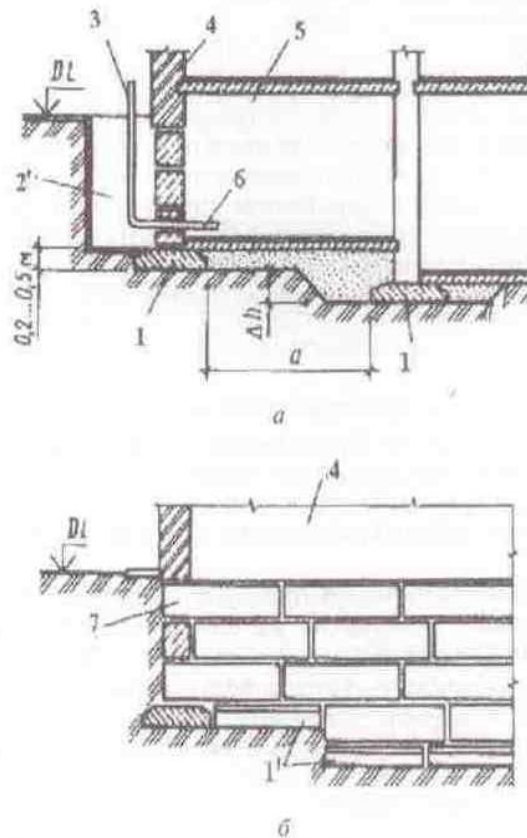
Вибір глибини закладання фундаменту в залежності від конструктивних особливостей споруди: а – будівля з підвалом у різних рівнях та прямком; б – зміна глибина закладання стрічкового фундаменту; 1 – фундаментні плити; 2 – прямком; 3 – трубопровід; 4 – стіна будівлі; 5 – підвал; 6 – ввід трубопроводу; 7 – стінові блоки
